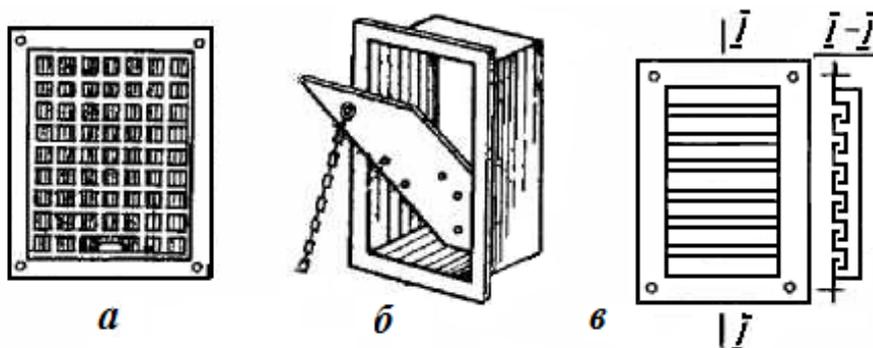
Оборудование приточных и вытяжных вентиляционных проемов:
